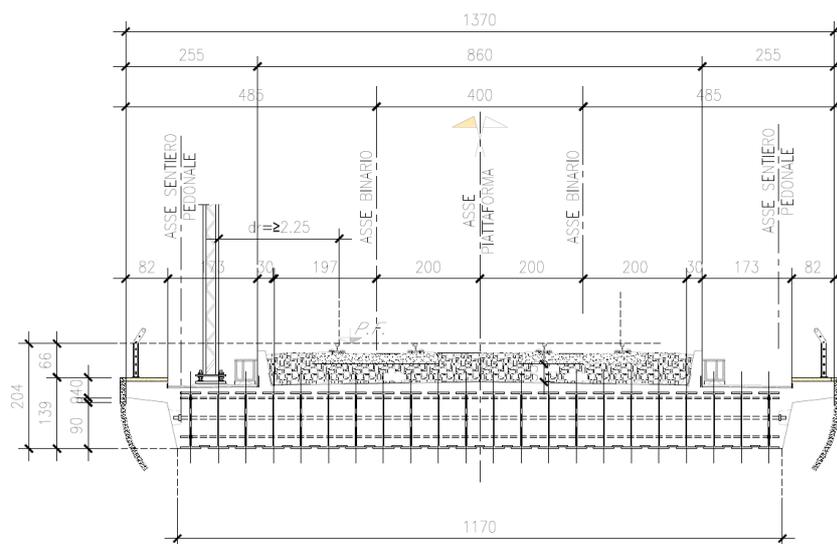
Impalcato a travi incorporate L = 20.0 m : sezione trasversale
